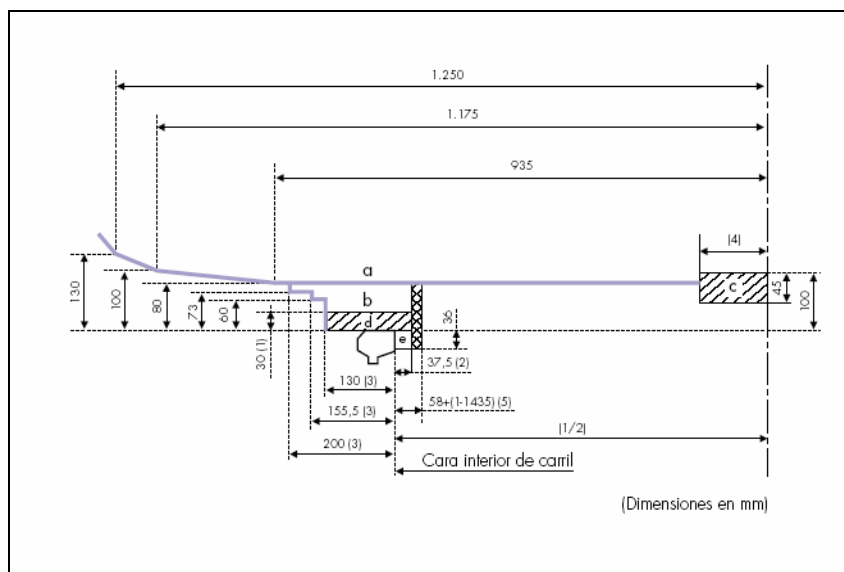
Gálbo ancho UIC (1.435mm)
